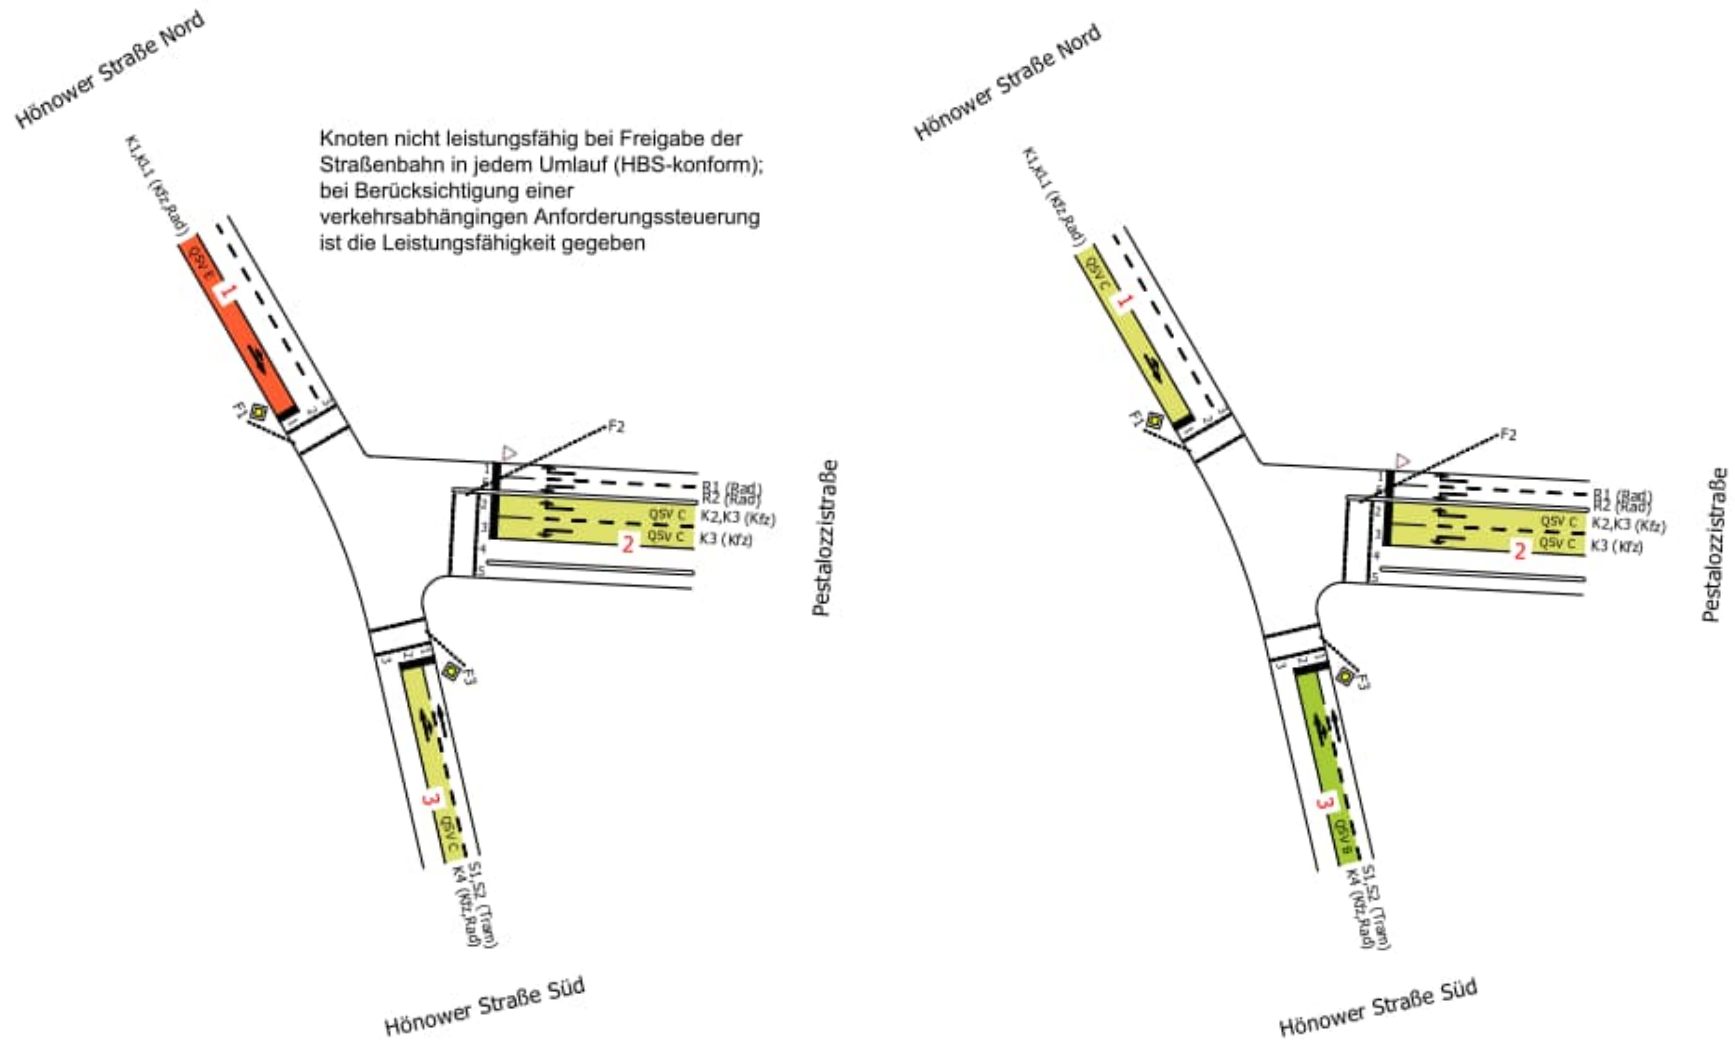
HBS-Bewertung des Knotens Hönower Straße / Pestalozzistraße, Frühspitzenstunde (links: mit Straßenbahn, rechts: ohne Straßenbahn)
